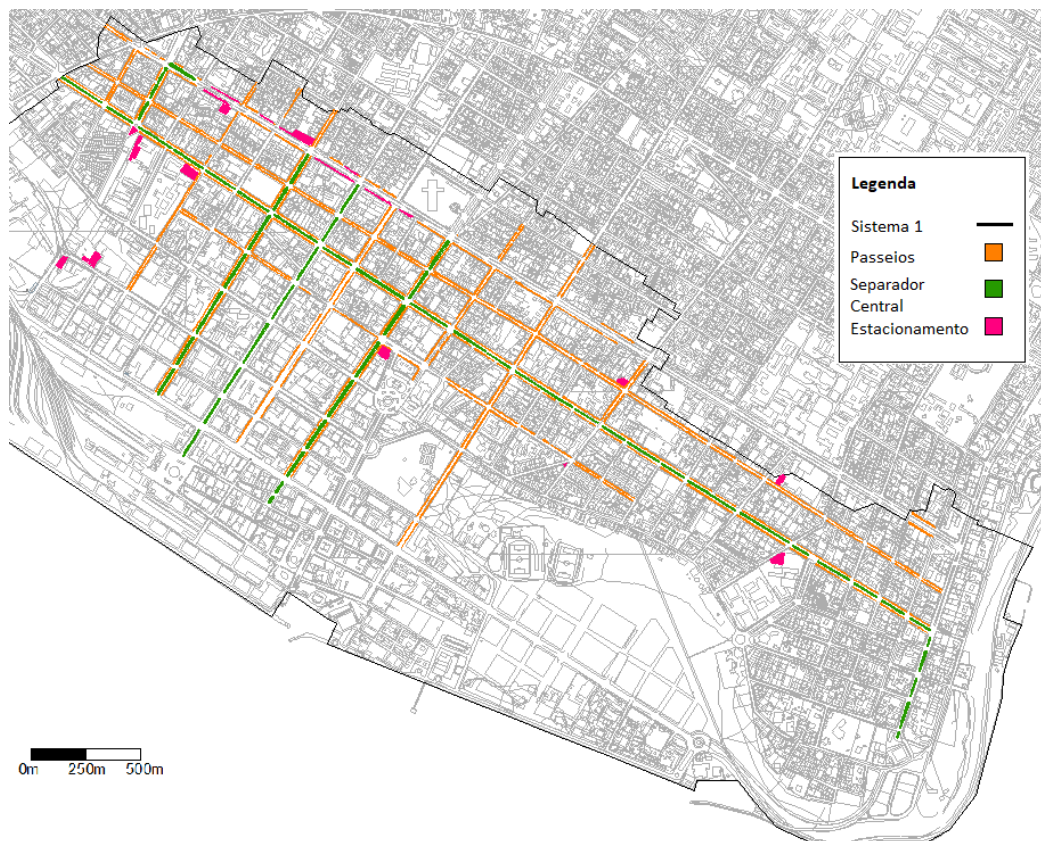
Planta de localização de soluções de controlo na origem propostas no Sistema 1.
